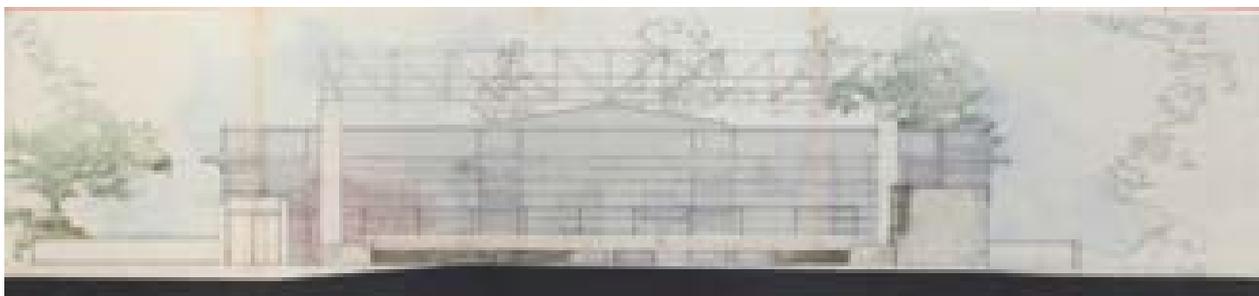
Prospetto Nord, stato futuro – opere di completamento – 11/06/1997 (AABS-624)
